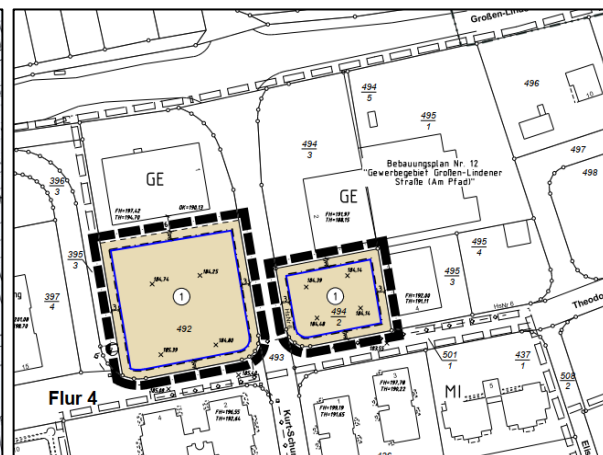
Bebauungsplan Nr. 12 – 3. Änderung (2009)
